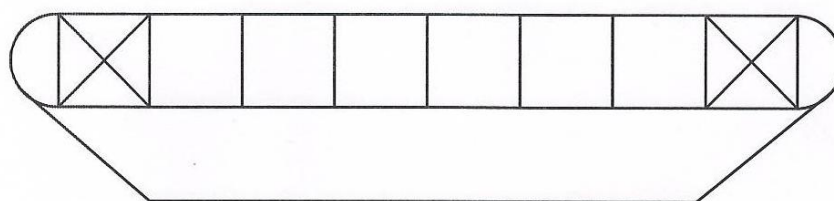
Общий эскиз резервуаров РТС-5000
